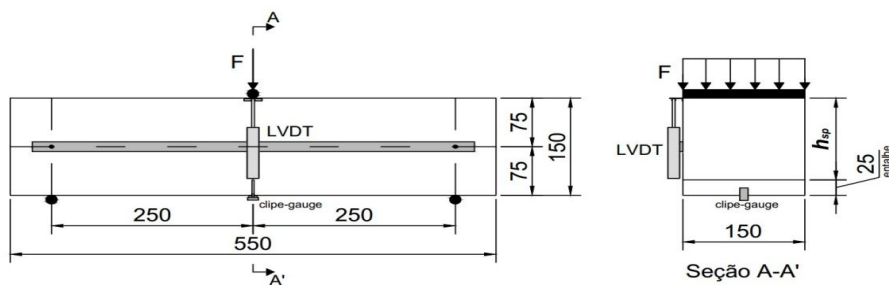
Ensaio de flexão (adaptado RILEM TC 162-TDF, 2002).
